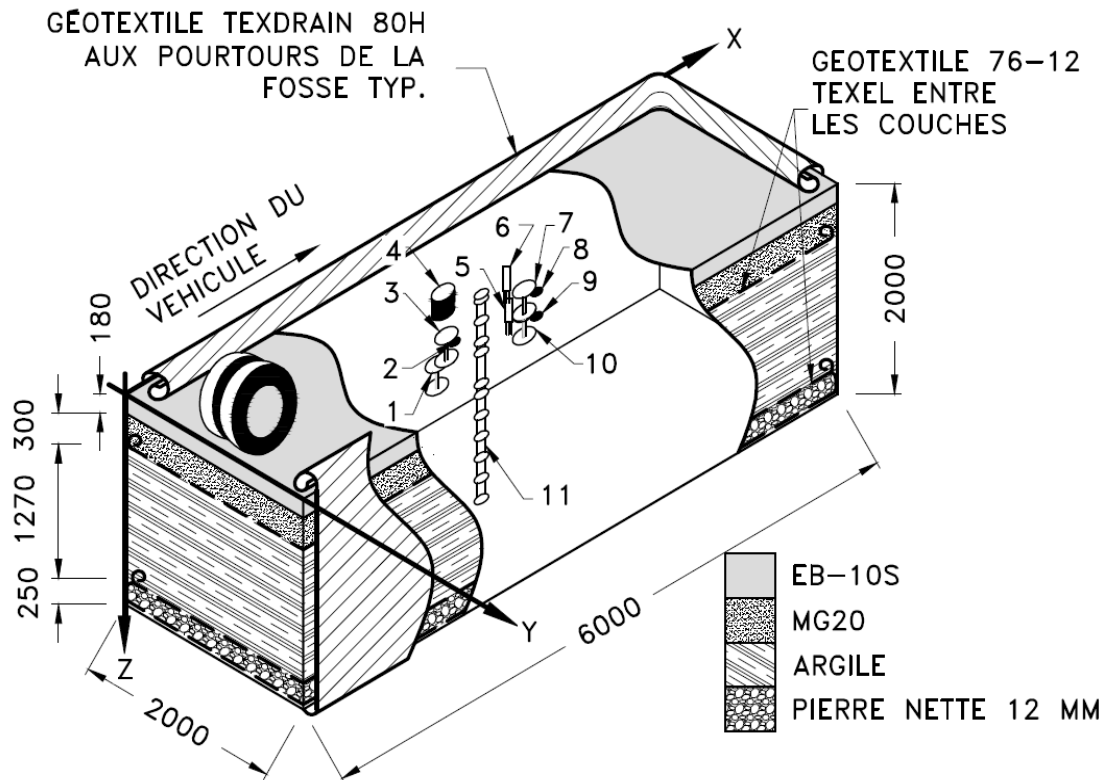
Croquis tel que construit de la chaussée et de l'instrumentation
